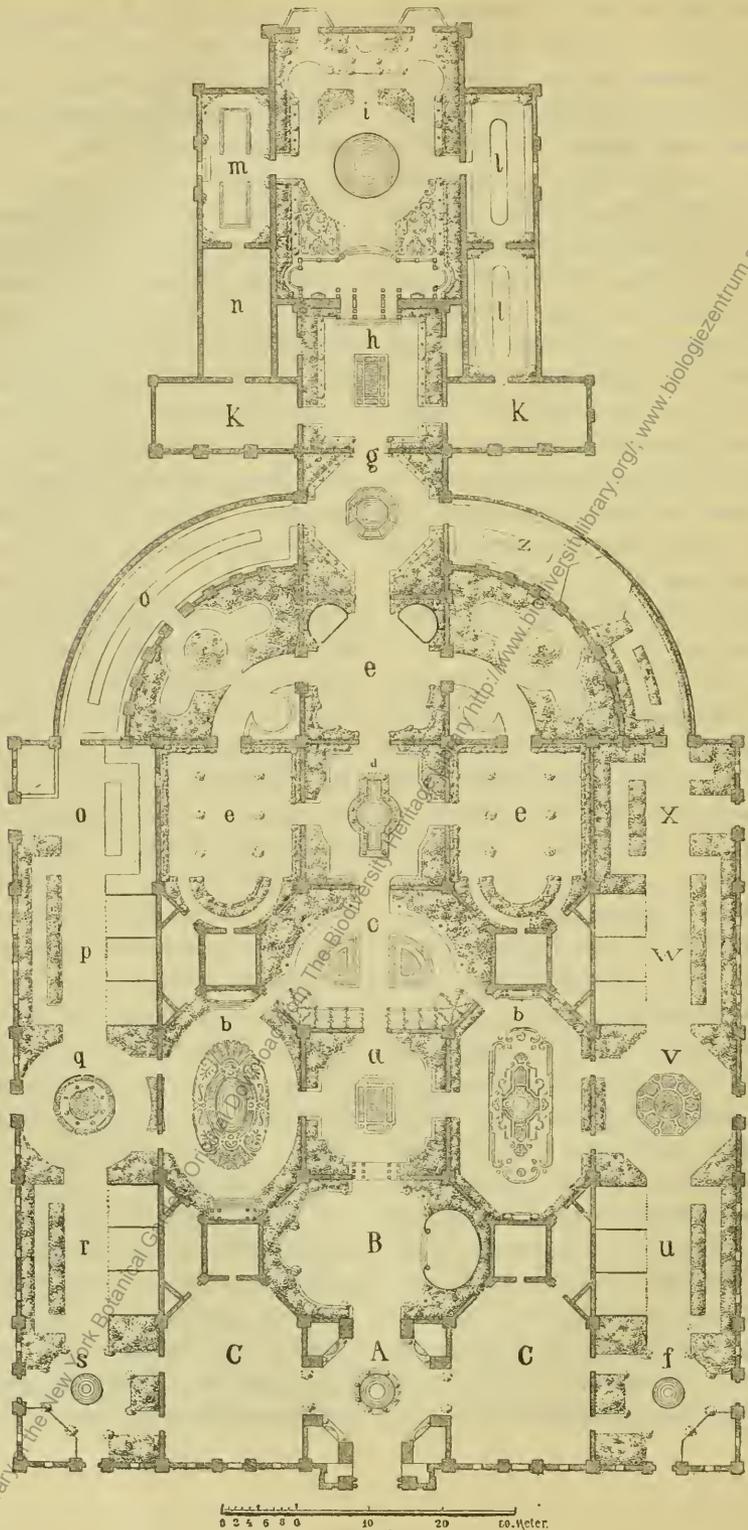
Plan der Gartenbau-Ausstellung in Berlin 1890.
